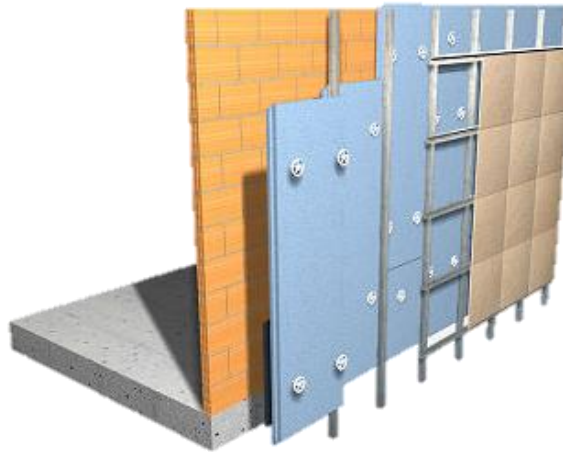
Aplicação de isolamento, pelo exterior em fachadas ventiladas, *Fonte : CYPE
